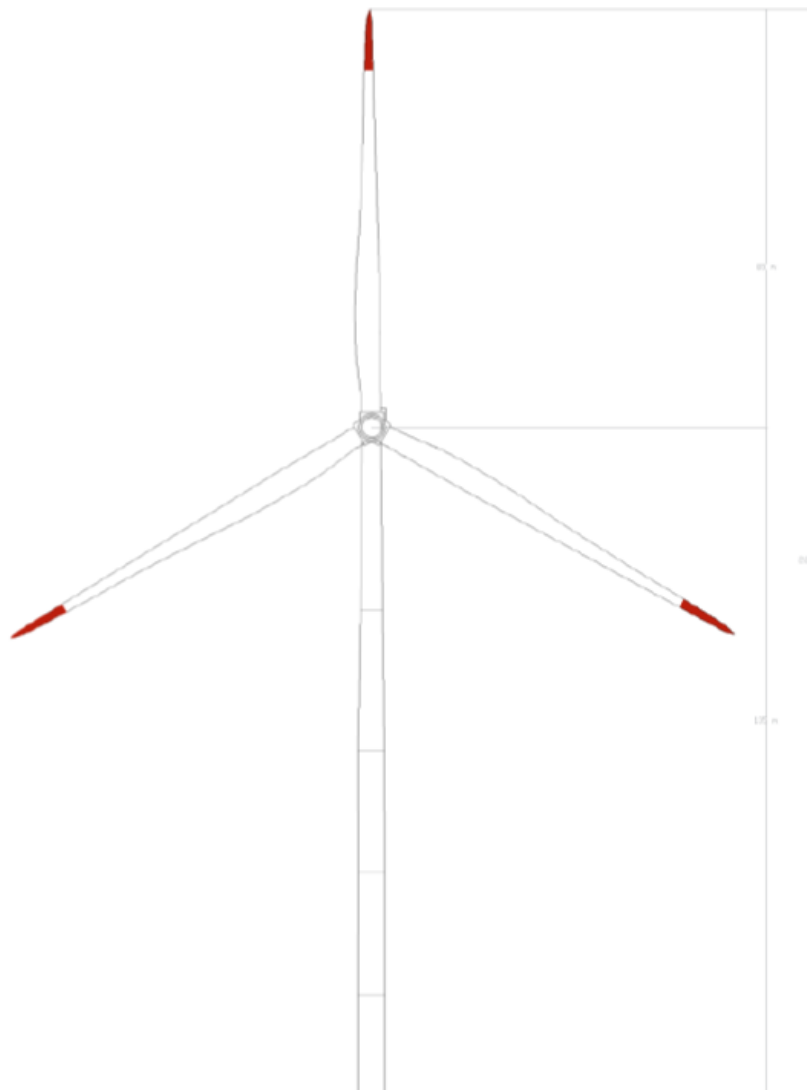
Segnalazione cromatica su prospetto frontale dell'aerogeneratore
